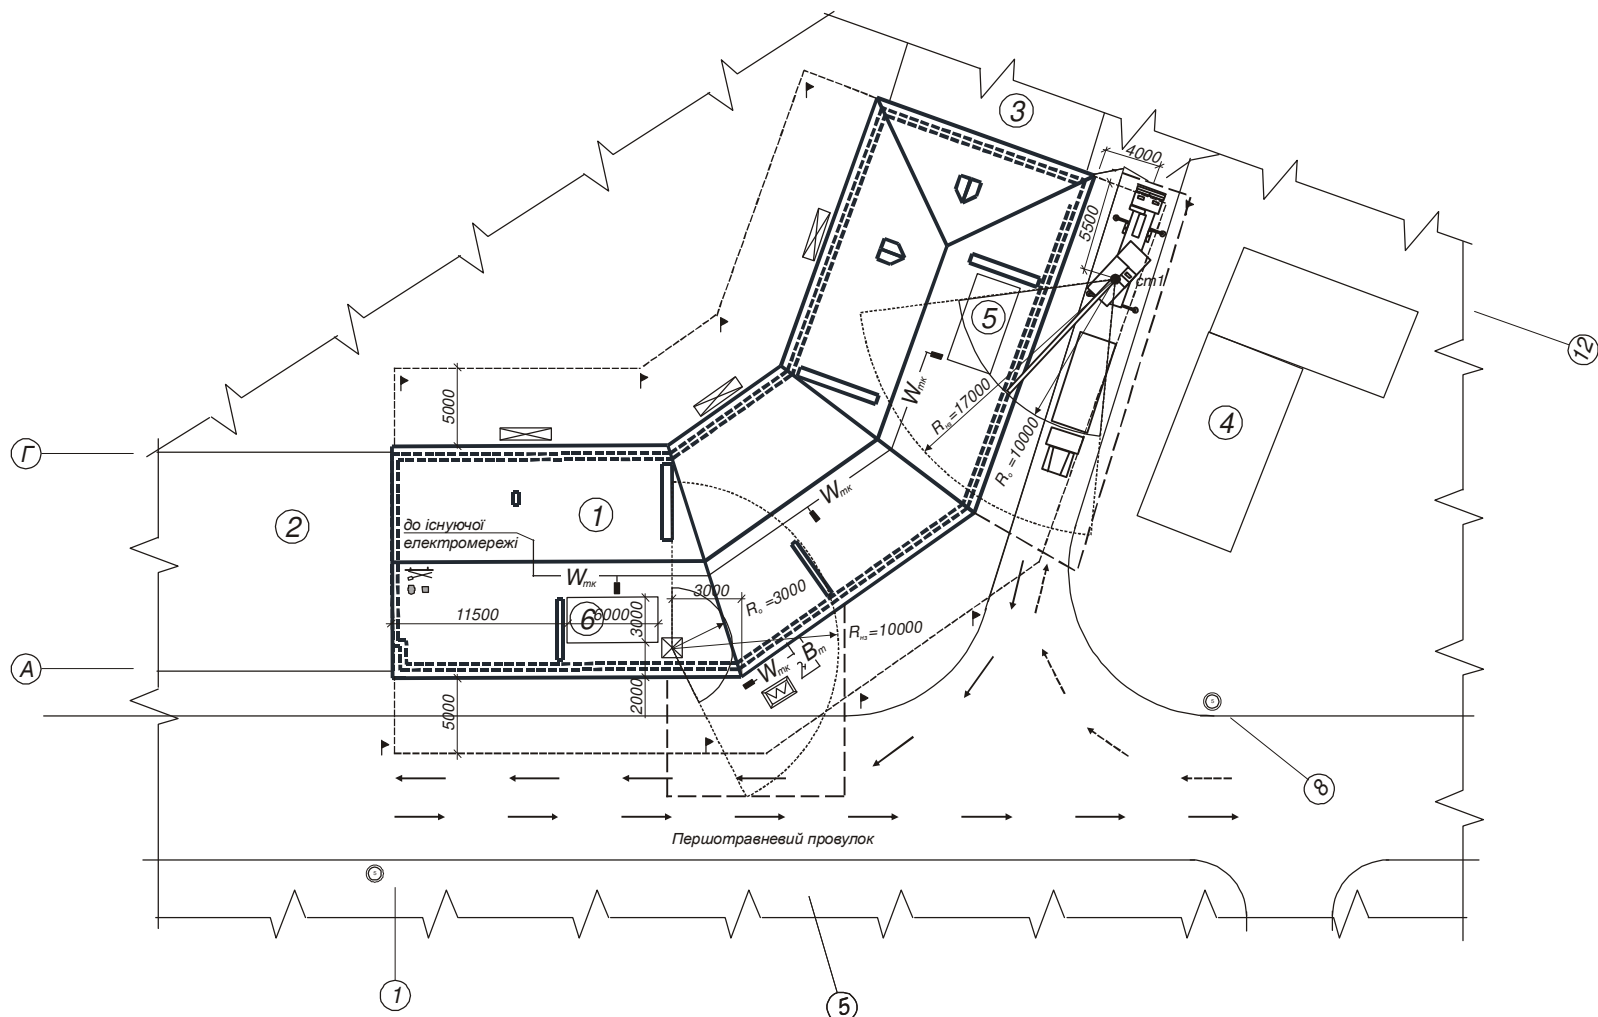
Будівельний генеральний план реконструкції покрівлі житлового будинку
